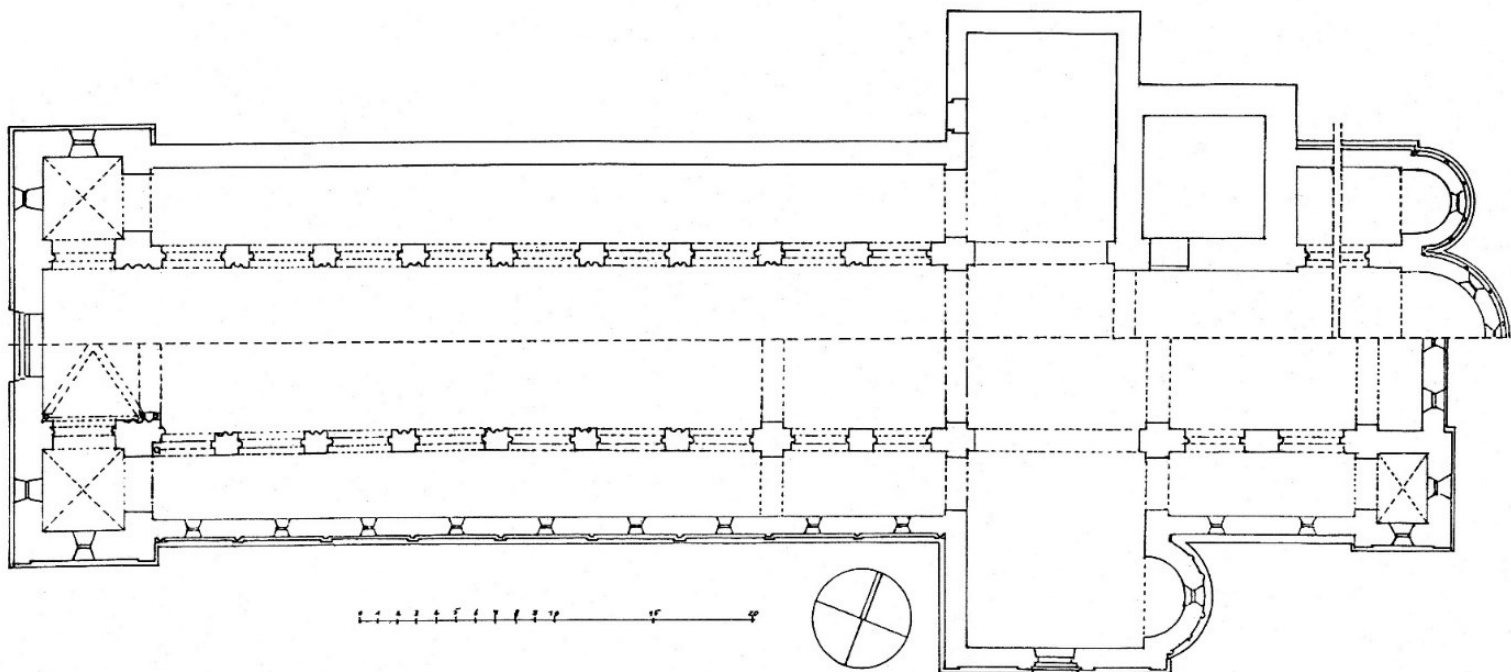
Erfurt, Peterskirche, Grundriss der ursprünglich geplanten und der ausgeführten Kirche, Haenchen 2000
